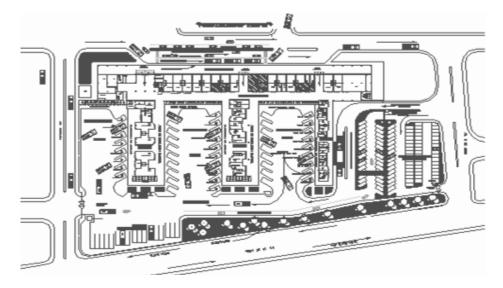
Plano arquitectónico de Terminal Terrestre de Portoviejo. Fuente: Municipio de Portoviejo. 2009
